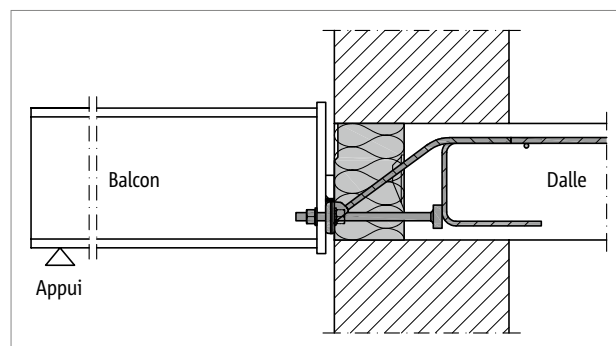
Schöck Isokorb® XT type SQ : raccordement à la dalle en béton armé ; mur avec isolation répartie
